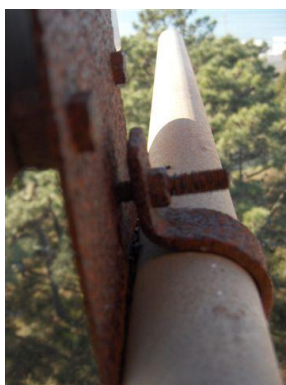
Abraçadeiras de fixação dos interfaces com elevada corrosão
